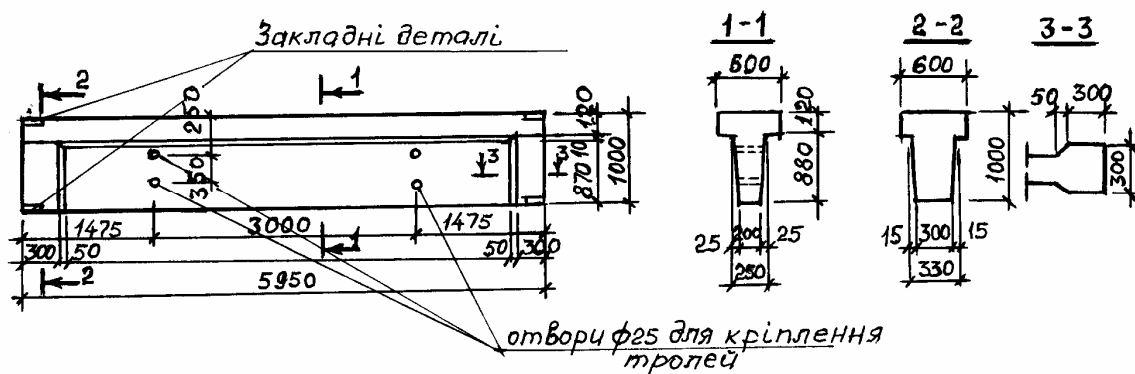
Опалубка підкранової балки прольотом 6 м
